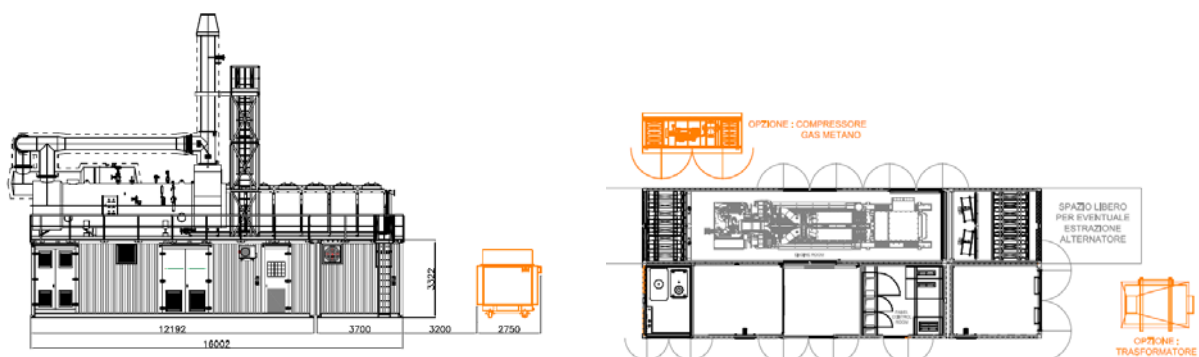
Prospetto e planimetria dell'impianto di cogenerazione in progetto
